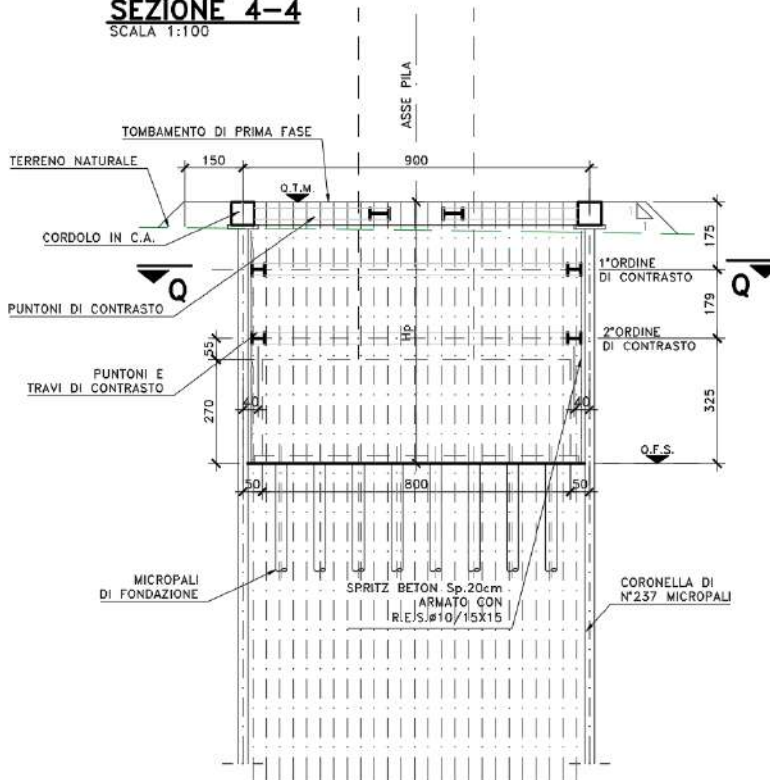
Sezioni opere provvisionali – Pila 2 SX
